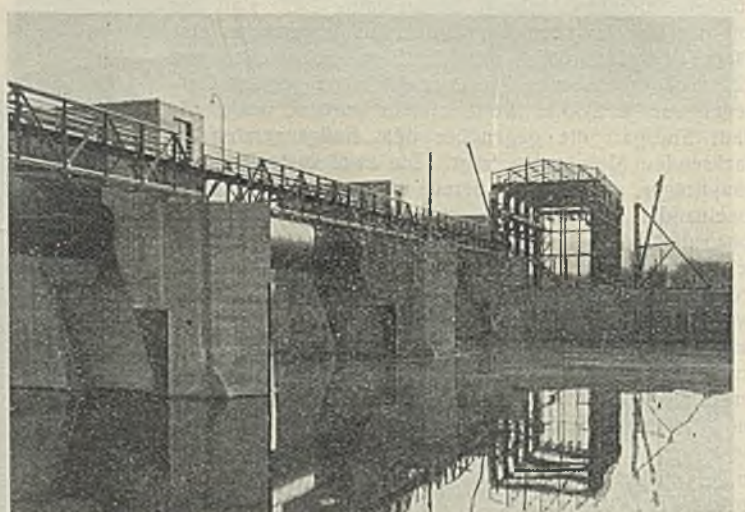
Staustufe Kleinwallstadt. Wehr und Krafthaus (Stahlskelettbau) vom Unterwasser aus.
